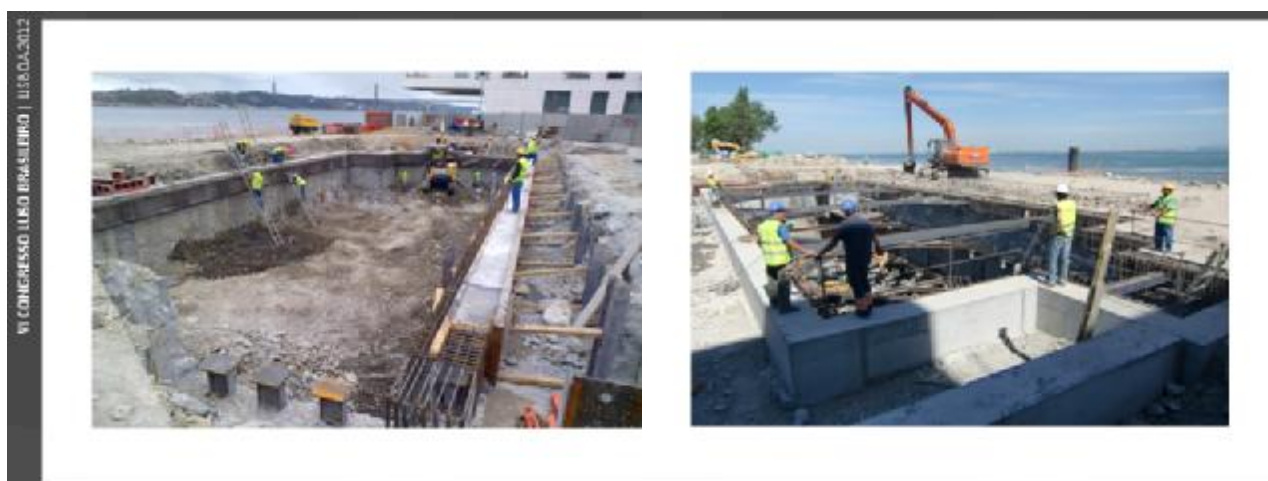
Execução da viga de coroamento. Primeiro nível de escoramentos colocado ao nível da viga de coroamento.
